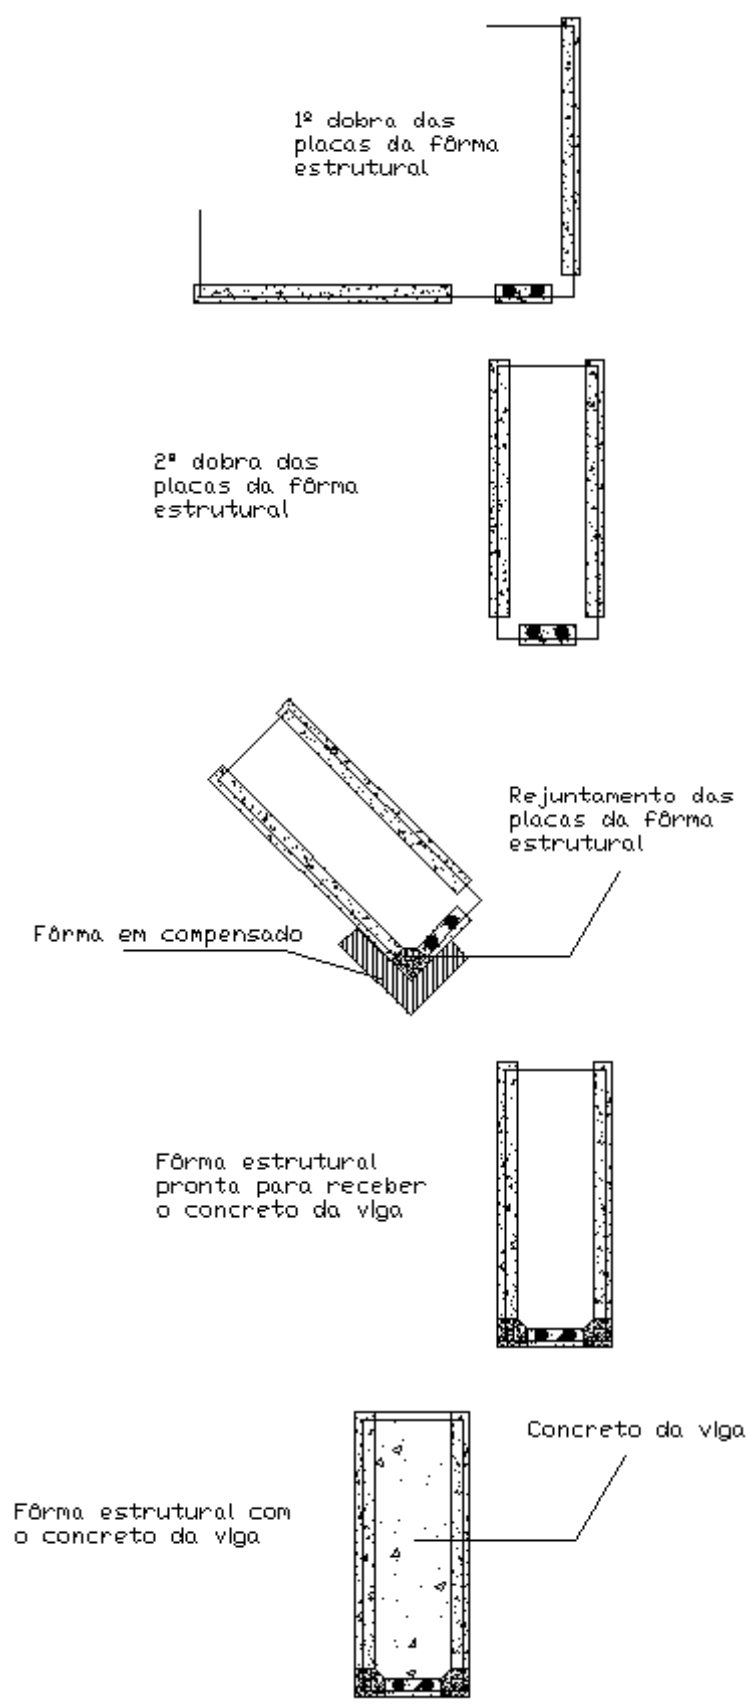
Esquema de dobra e rejuntamento da forma estrutural e concretagem da viga experimental 1 (MASSONI, 1996)
